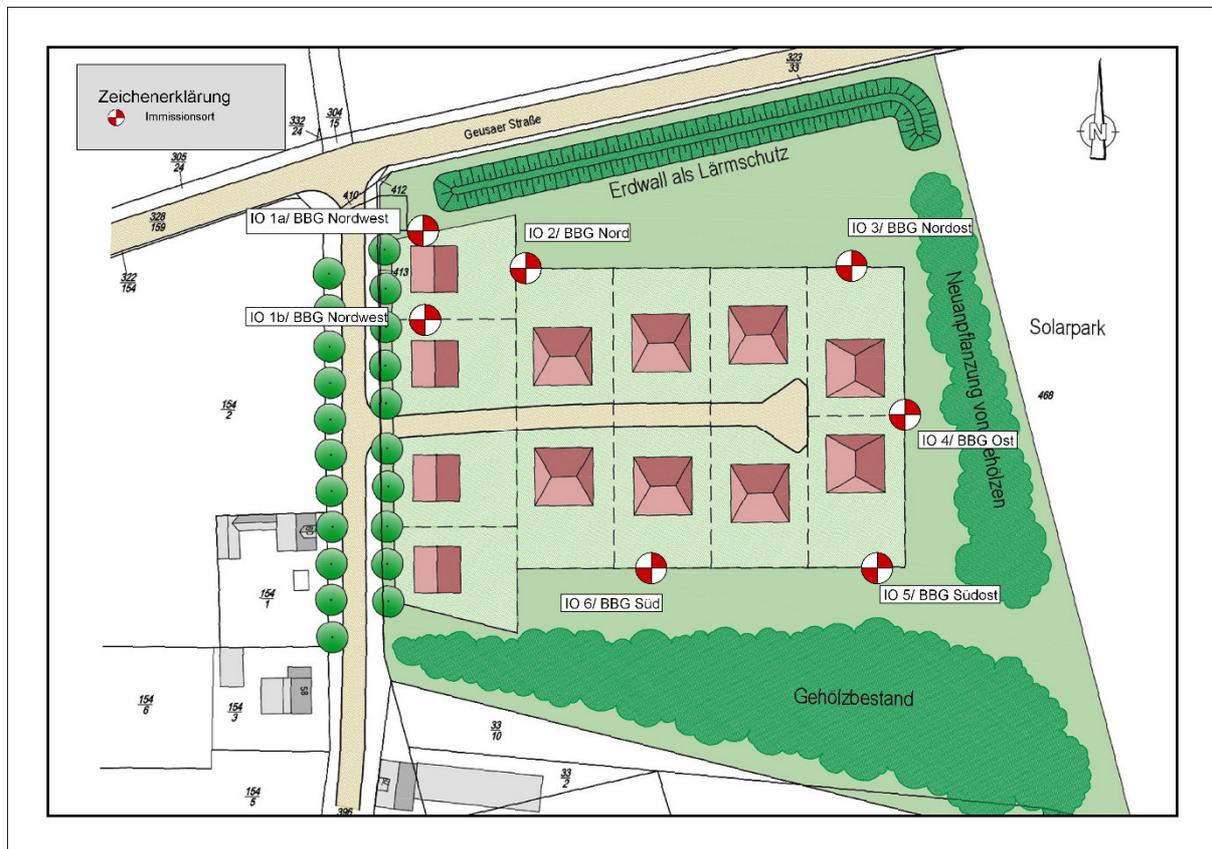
Geplante Wohnbebauung mit maßgeblichen Immissionsorte
